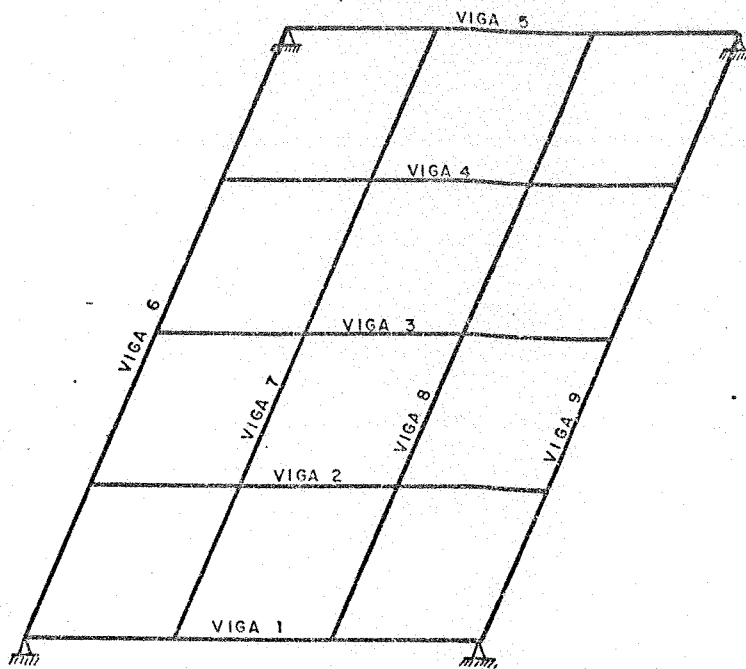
VIGAS DA ESTRUTURA.
